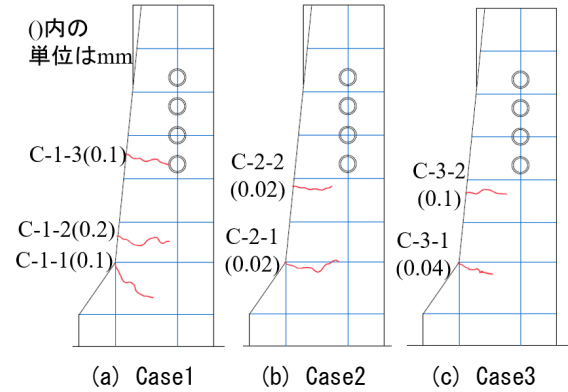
SS種設計荷重(138kN)時のひび割れ図
